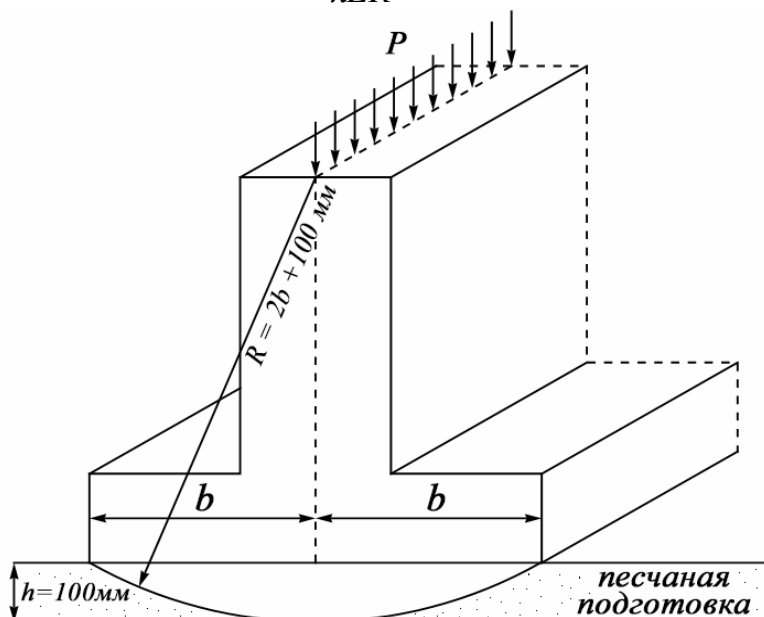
Схема фундамента с круглоцилиндрической подошвой:
